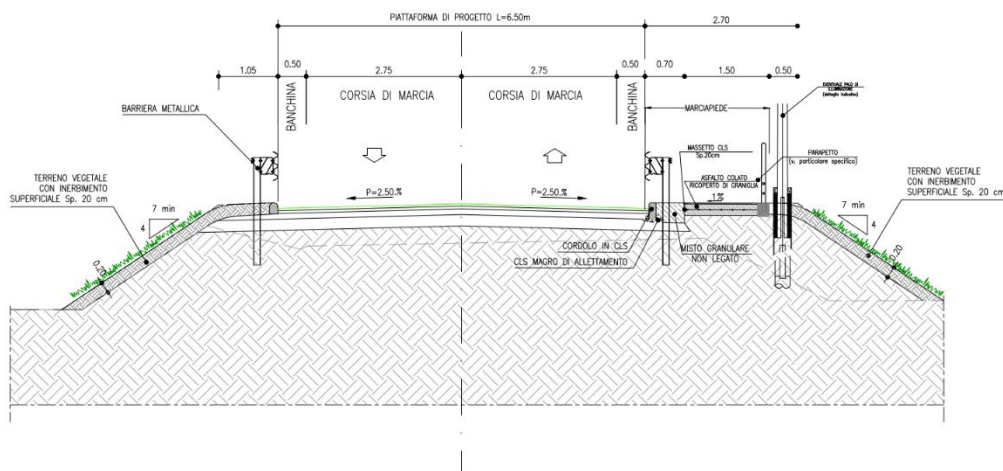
IN006 e Sezione tipo in rilevato – soluzione di variante
